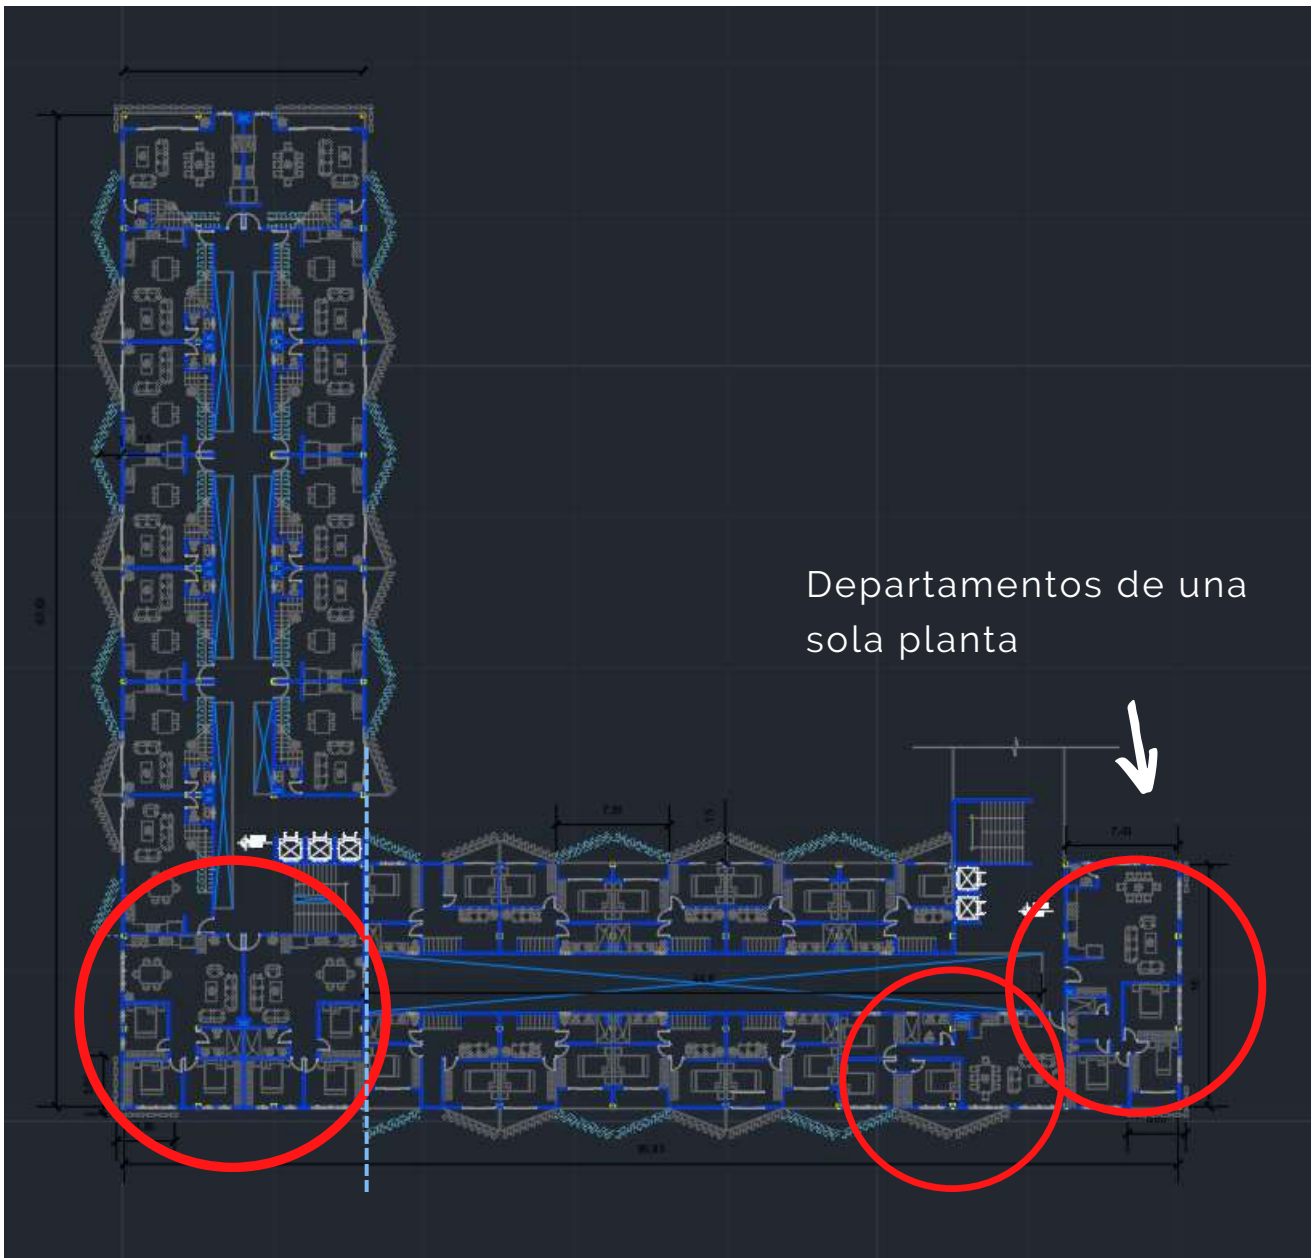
Planta arquitectónica. Fuente: Autoría propia.
